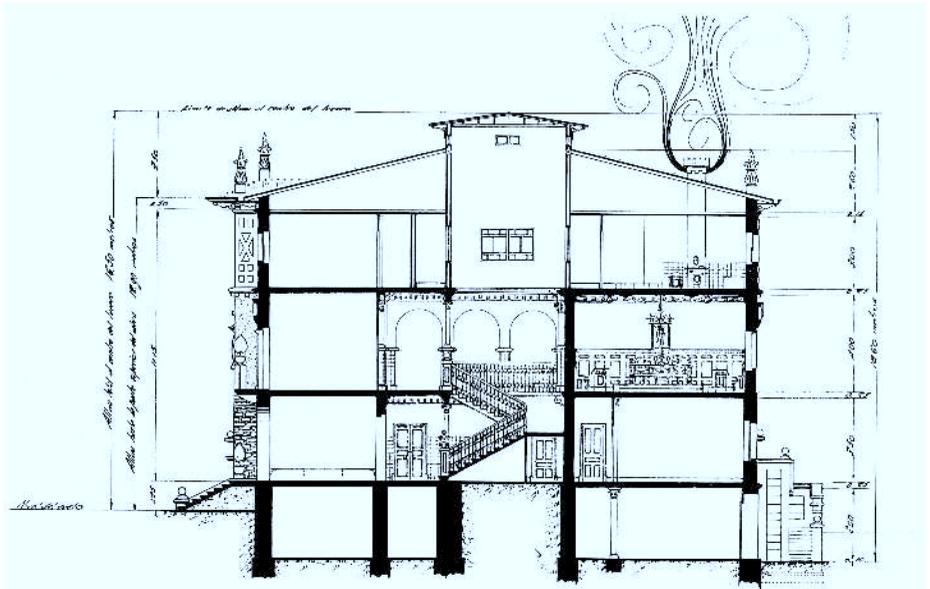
Proyecto para el Ayuntamiento de Carranza realizado en 1924 por el arquitecto Julio Sáenz de Barés. Sección. (Edificio no construido).
